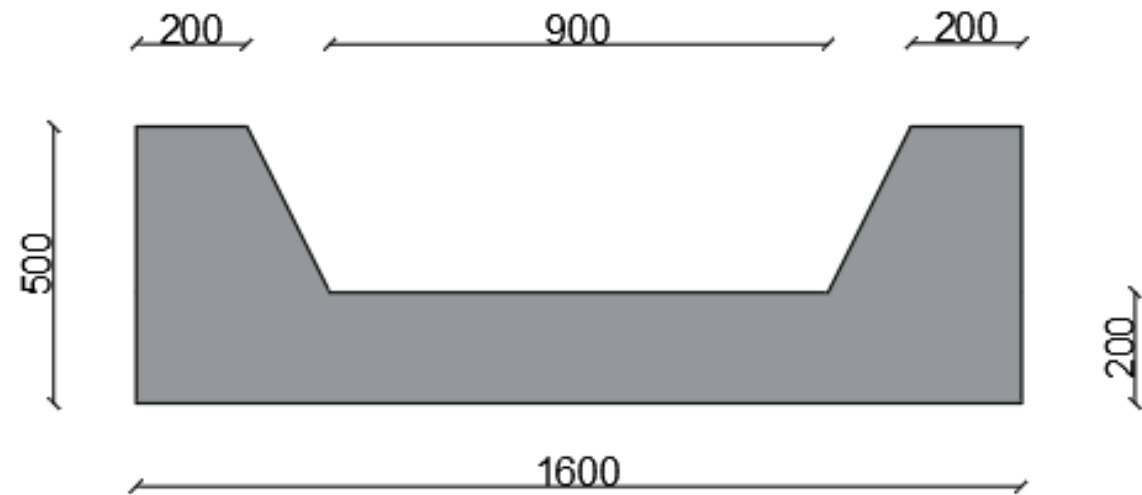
Sección cuneta de la berma de pie. Fuente: Elaboración propia.
